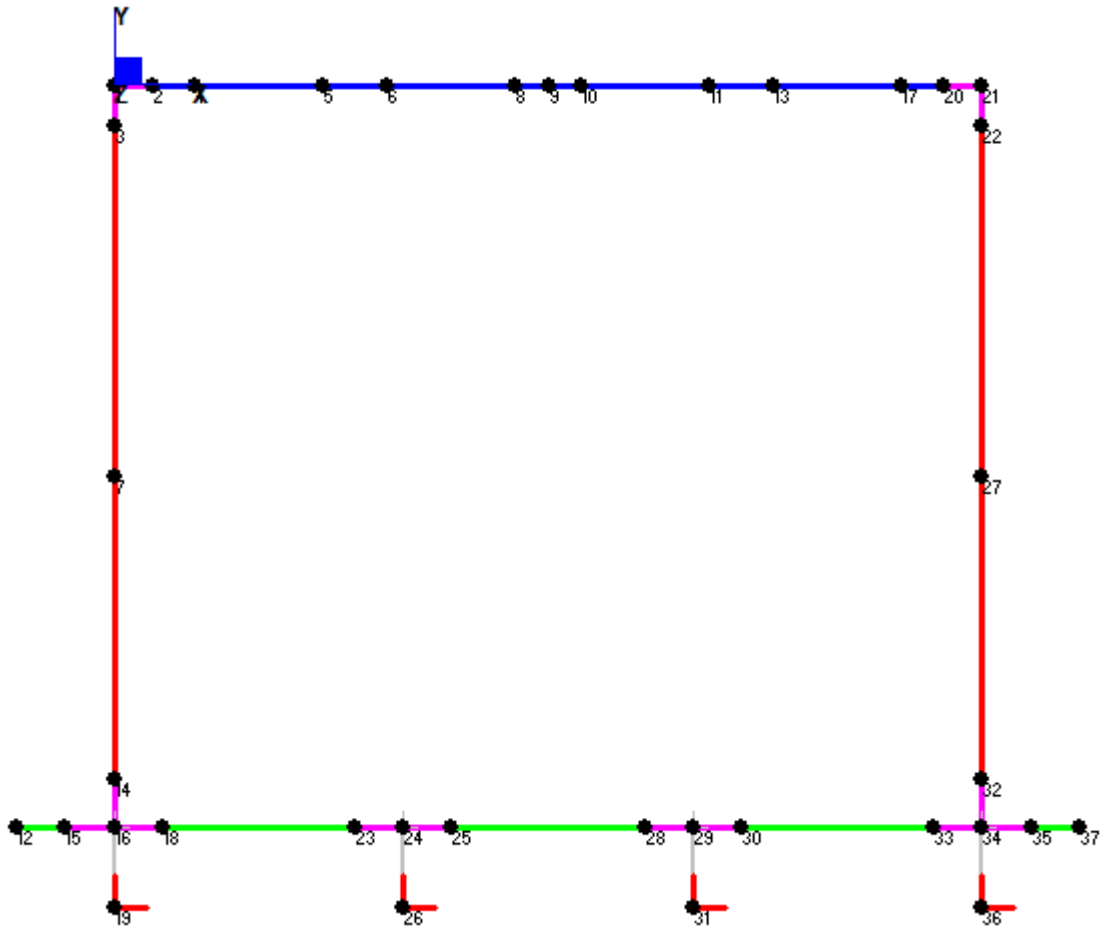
Modello trasversale spalla - Numerazione nodi
